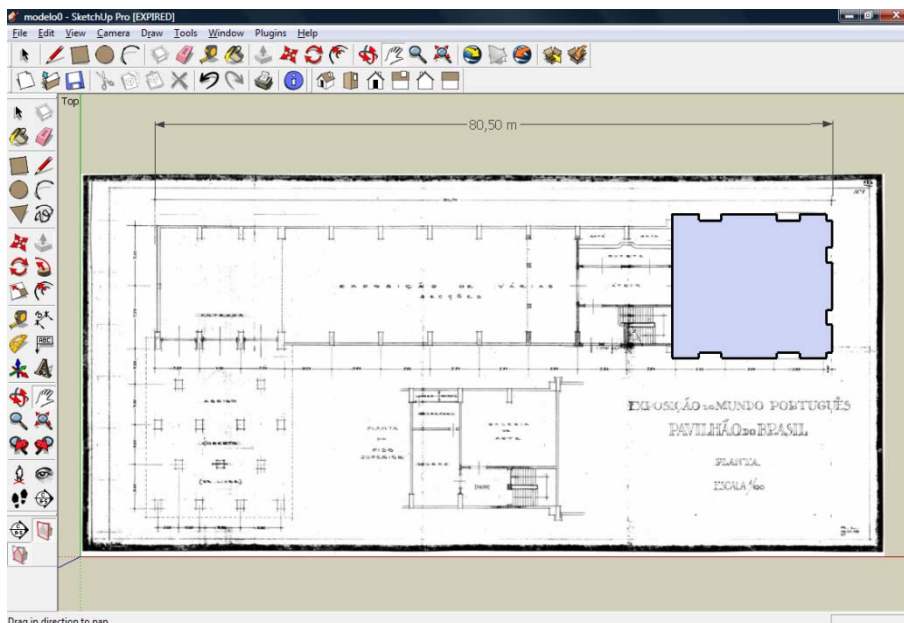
| PLANTA DO PAVILHÃO DO BRASIL. [RECONSTRUÇÃO].
